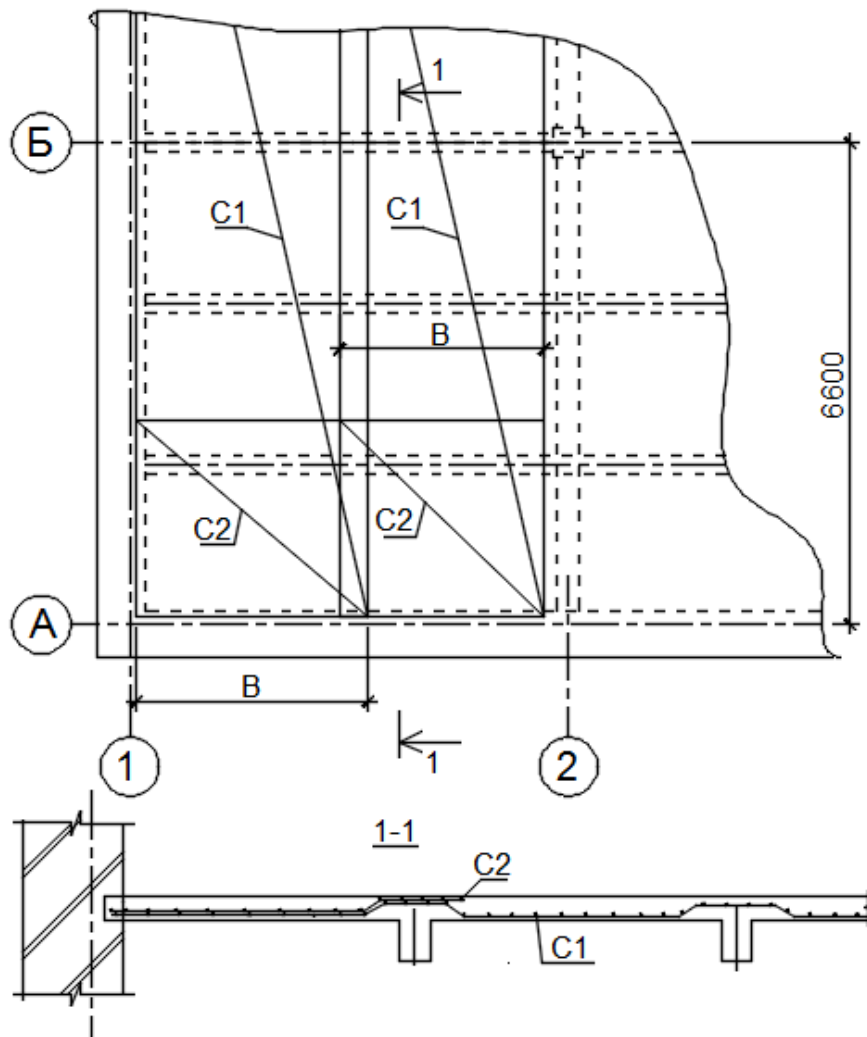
Фрагмент схеми армування рулонними сітками
